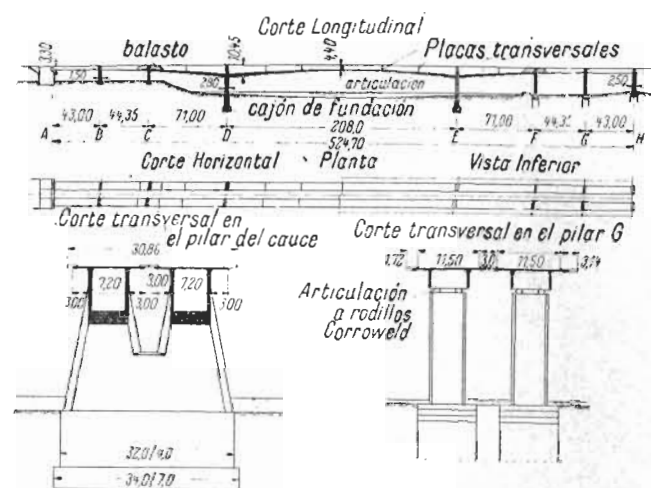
Puente Bendorf, sección I (oeste); cortes longitudinal y transversales en los pilares del cauce y el G.
